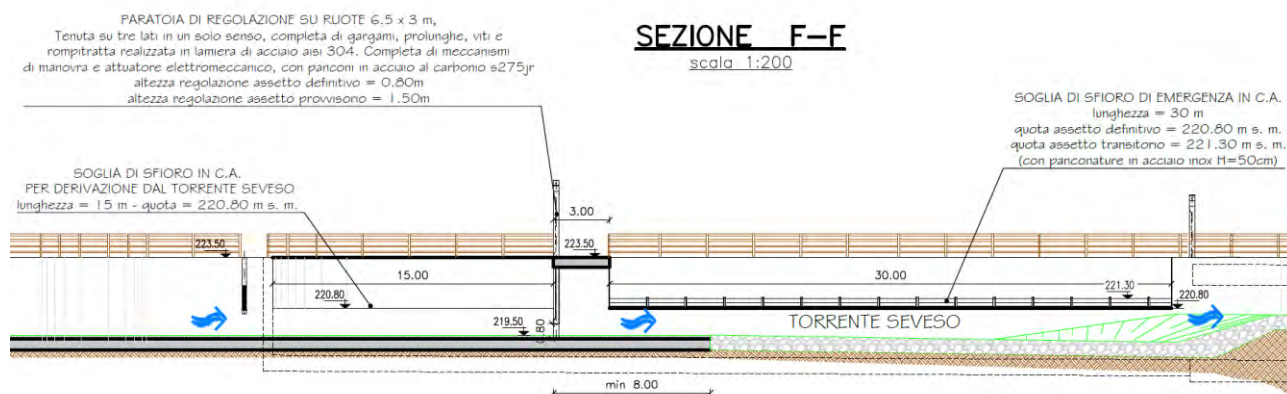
Sezione longitudinale di progetto dell’opera di presa dal T. Seveso
